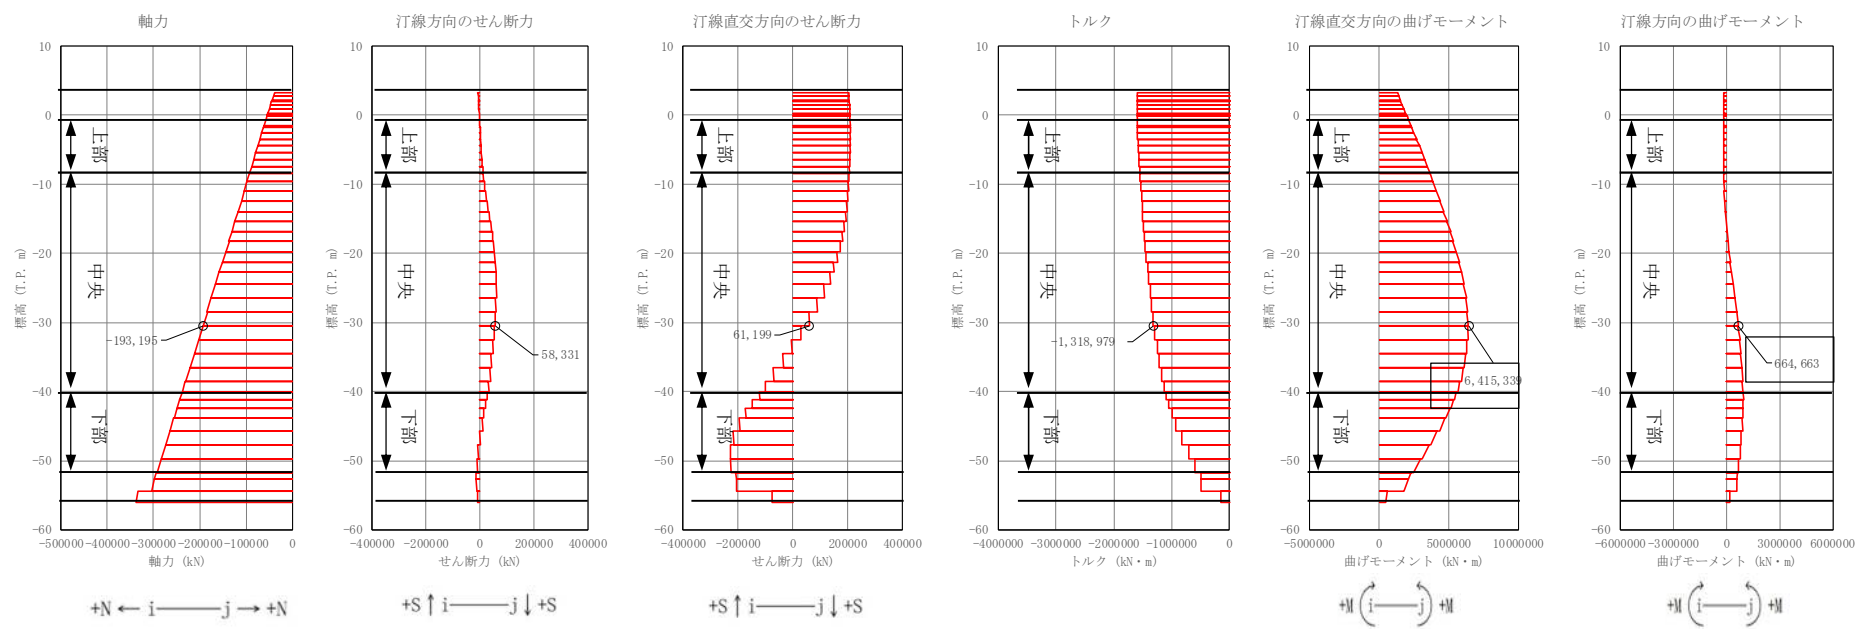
(6) 地中連続壁基礎において鉄筋の曲げ軸力照査結果が最も厳しい断面力
